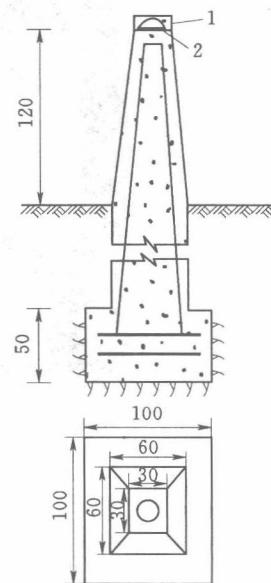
普通钢筋混凝土观测墩 (单位: cm)
